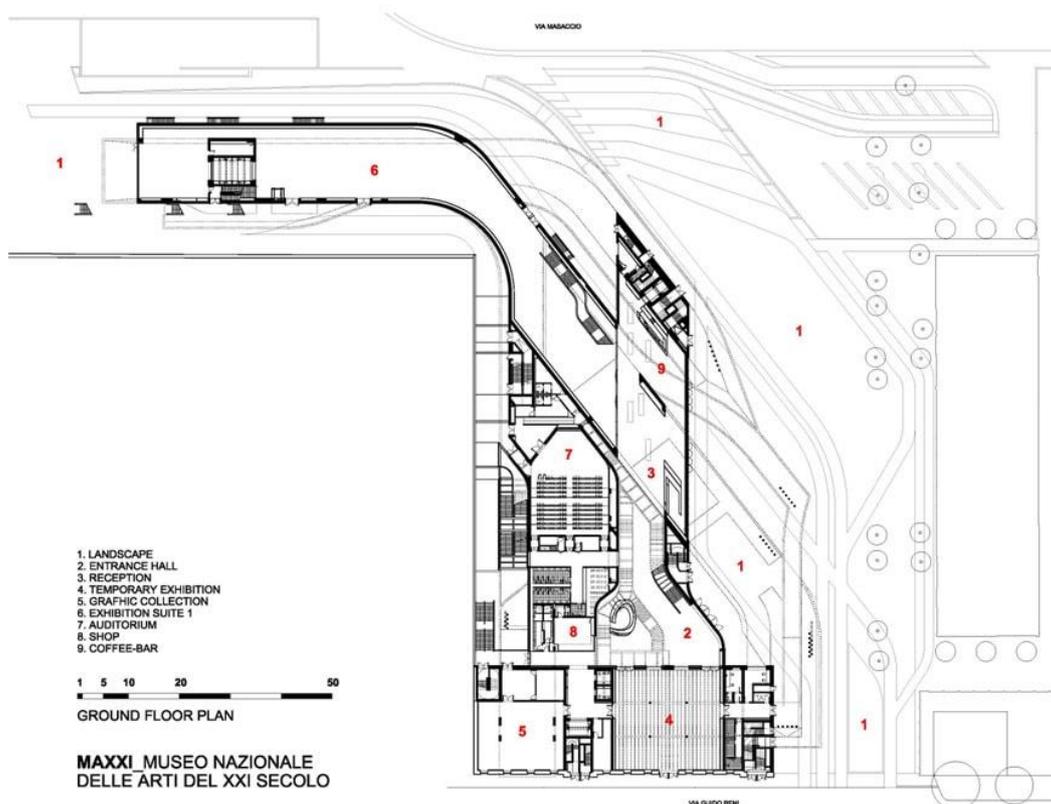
Pianta piano terreno (<https://www.zaha-hadid.com/>)
